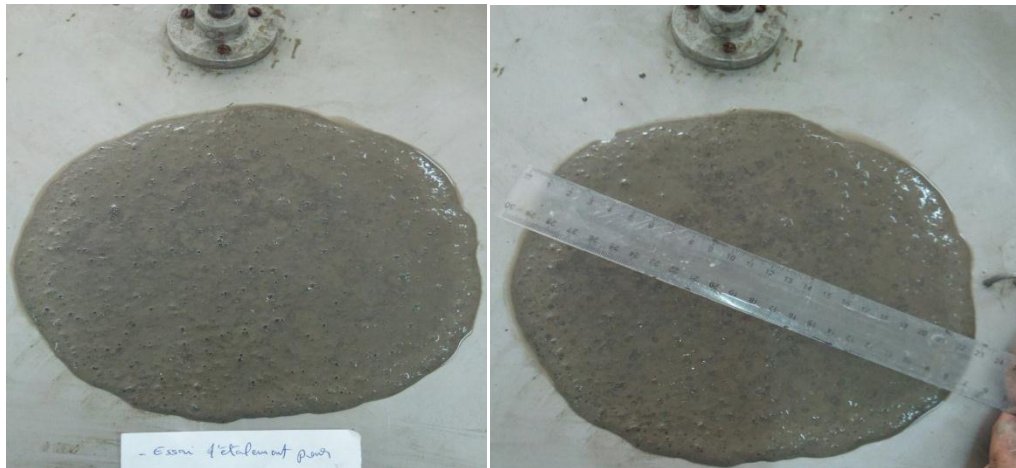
Essais d'étalement sur le mortier autoplaçant frais
